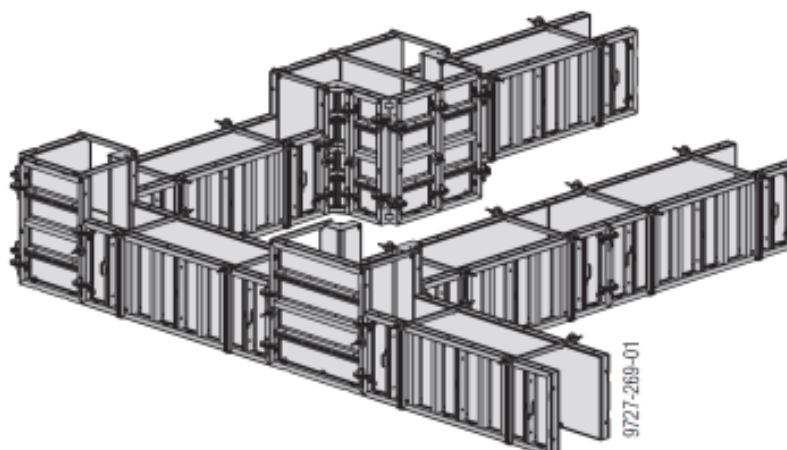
Aplicação do painel Doka Framax Xlife em fundações (Fonte: Doka, 2007).
